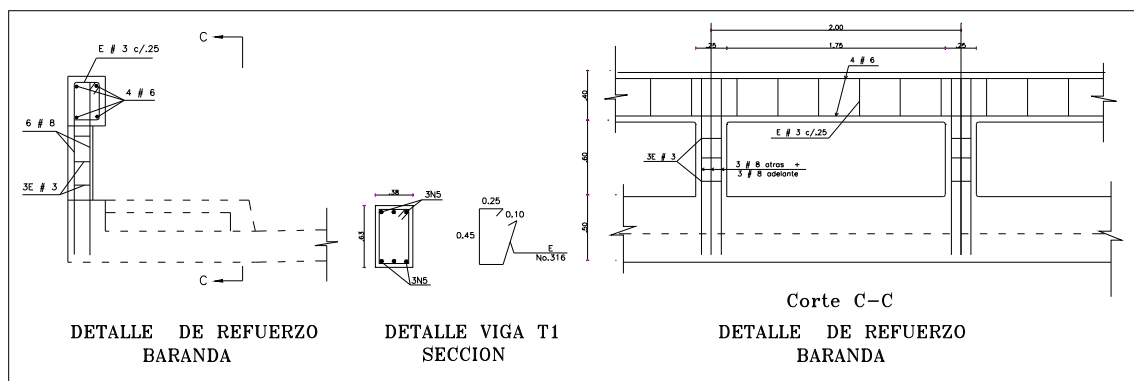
Construcción de la viga T1 y colocación refuerzo para postes de la baranda
